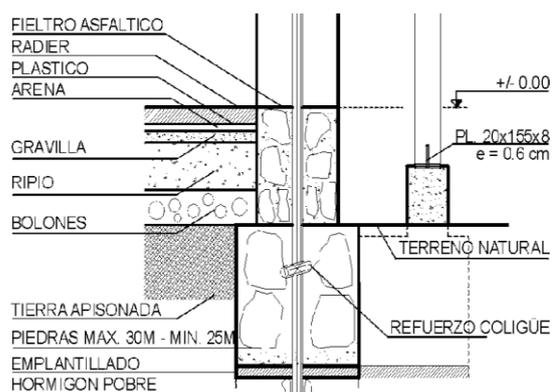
Detalles de cimientos y cubierta del muro de tapial
